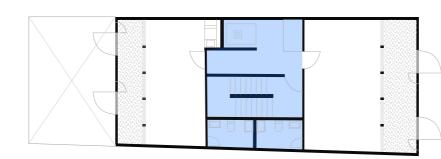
Planta base edificio Bonpland. Fuente: Elaboración propia, basado en revista PLOT (2018)
